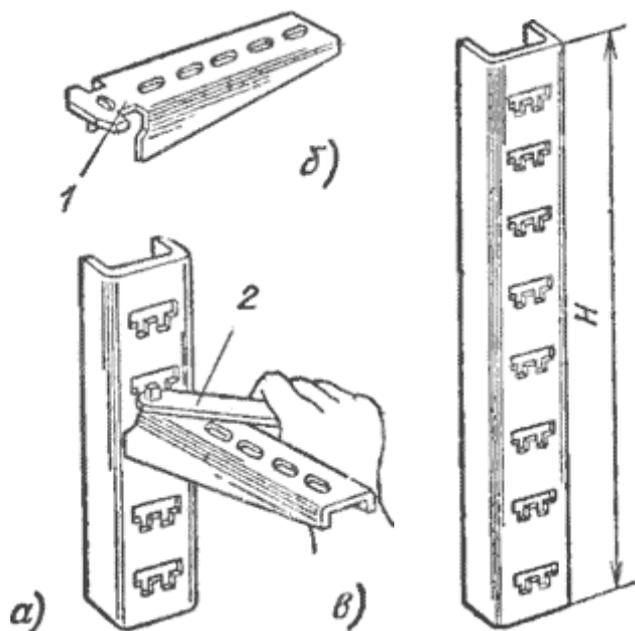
Сборные кабельные конструкции и их детали: а — стойка; б — полка; в — крепление полки; 1 — язычок; 2 — поворот язычка ключом
